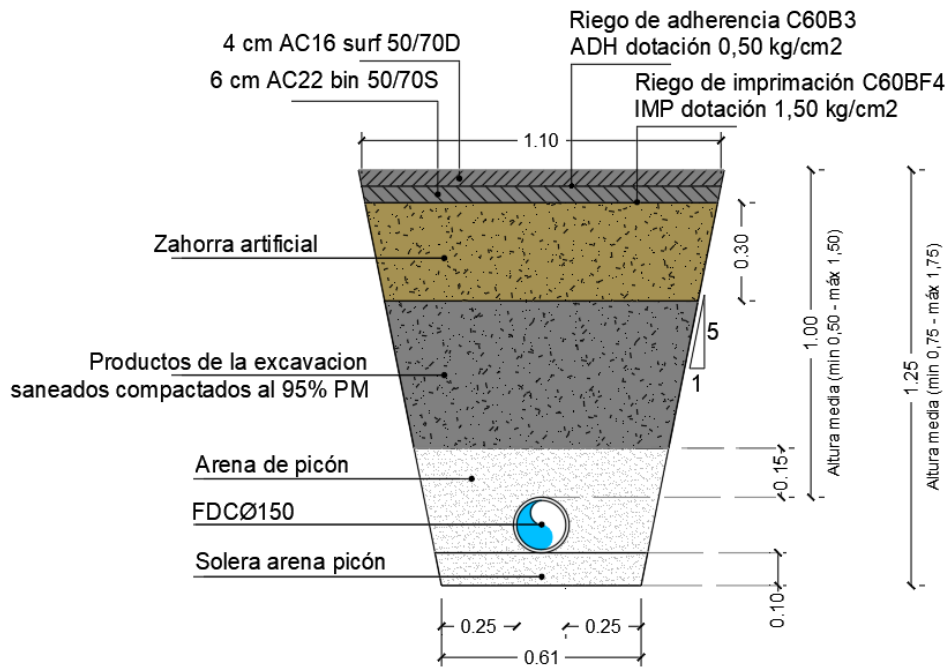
Figura V. Sección tipo en tramo de calzada. Aducción o distribución.
